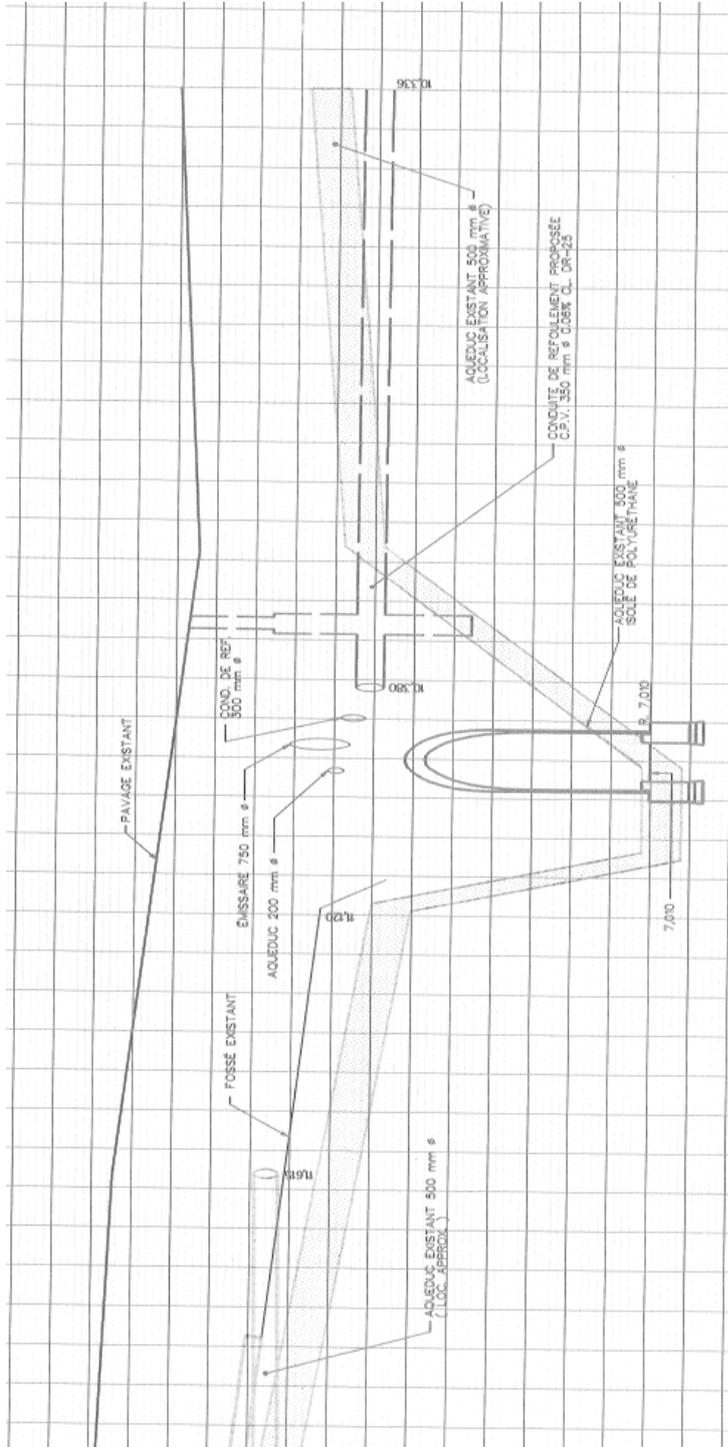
Ponceau boulevard Pierre-Le Gardeur.
